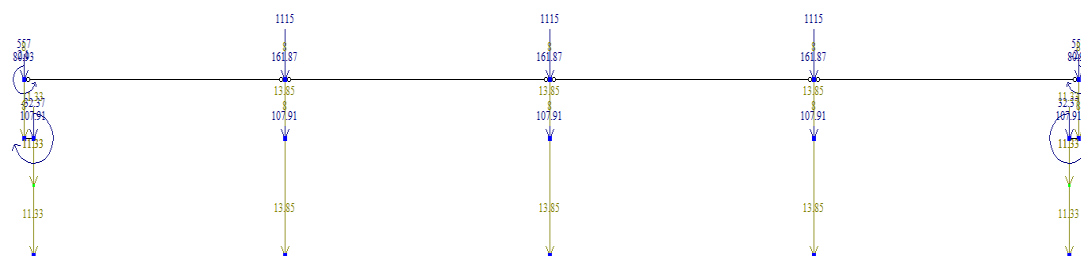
Розрахункова схема будівлі від постійного навантаження
